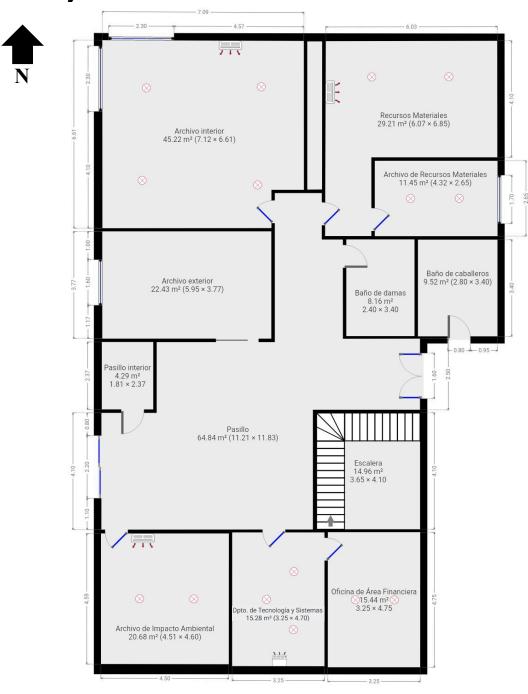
Croquis de la planta baja del edificio. Fuente propia (2021).
